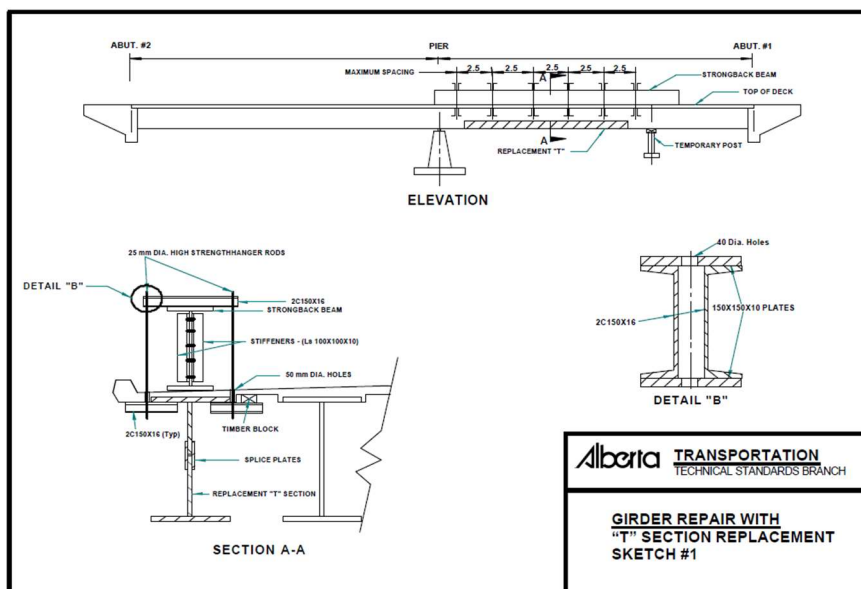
Princípio esquemático da substituição da secção T inferior de uma viga, com recurso a chapas de emenda (Alberta Transportation, 2004)
